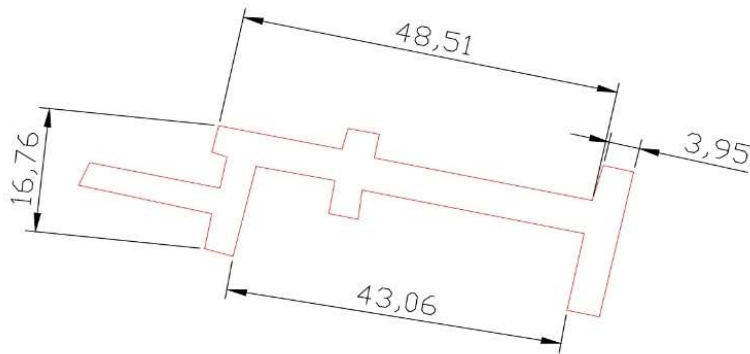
Particolare costruttivo e dimensionale della "Santa Barbara" di Cà Pasi
